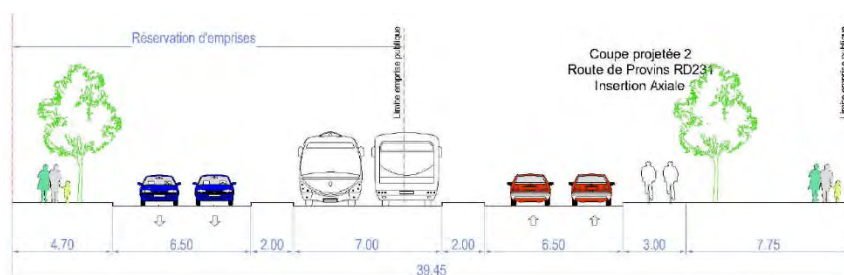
Coupe projetée sur la RD 231 – source : SYSTRA
